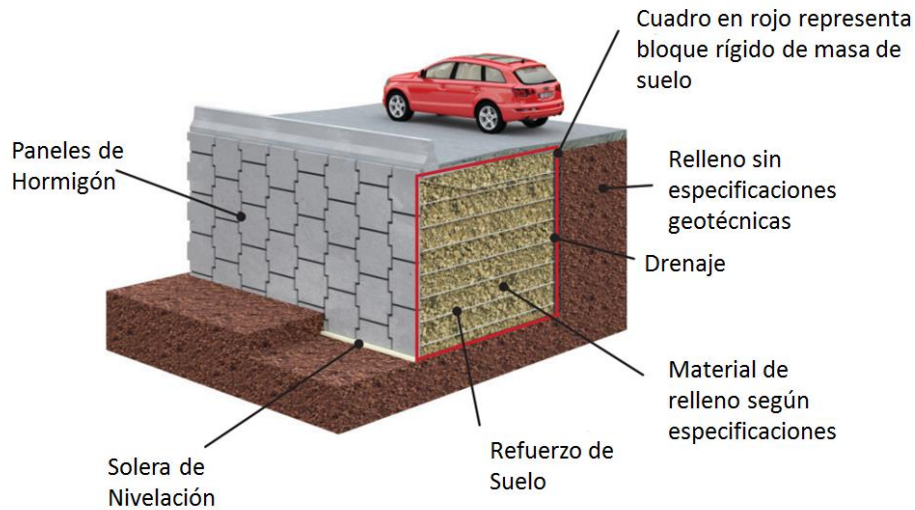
Esquema muro mecánicamente estabilizado. Adaptada de Tierra Armada.
